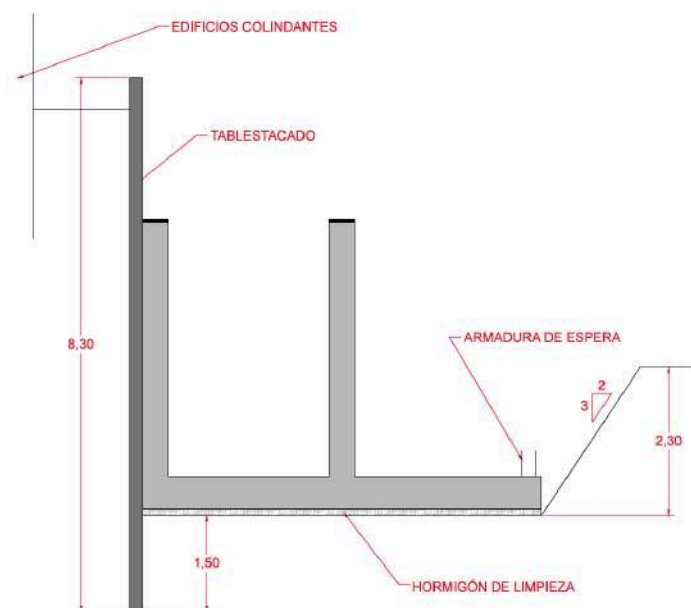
Sección estándar durante su construcción bajo la calle Barranc. FUENTE: Elaboración propia.
